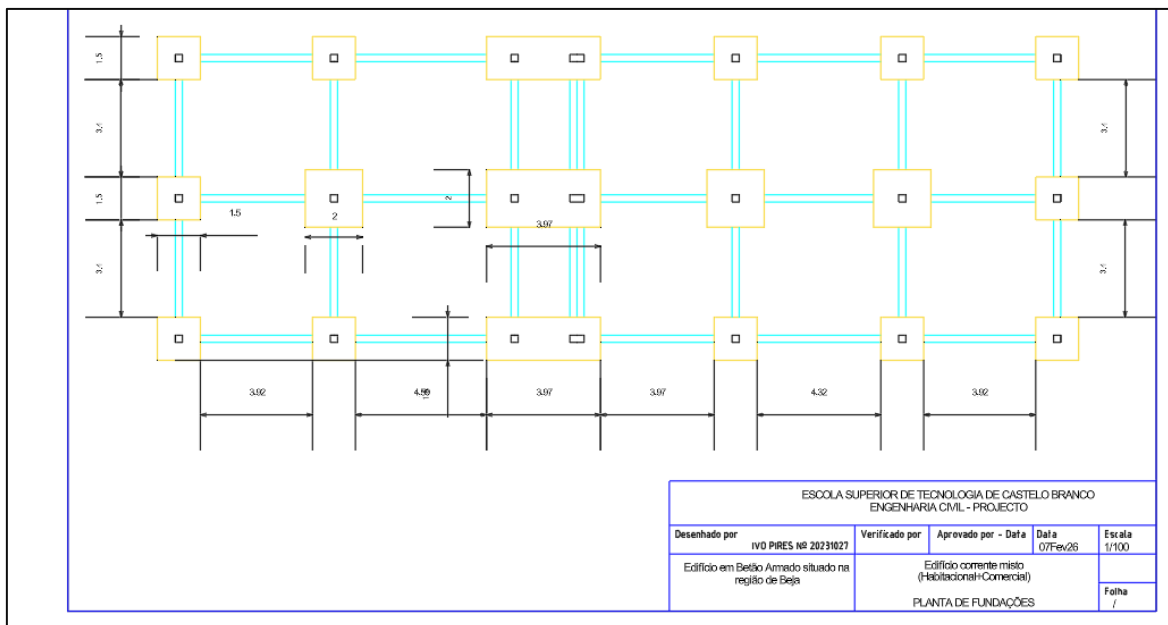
Planta de fundações: Desenho do AutoCad segundo pré-dimensionamento, desenho proposto pelo autor deste trabalho
